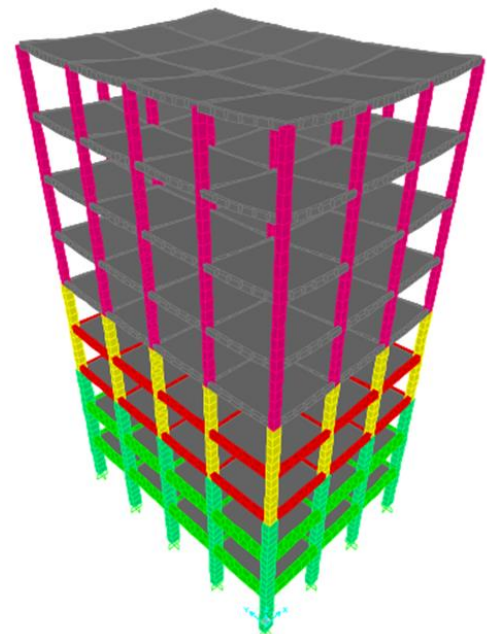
Model Struktur 3D Banguna Gedung Lantai 7
